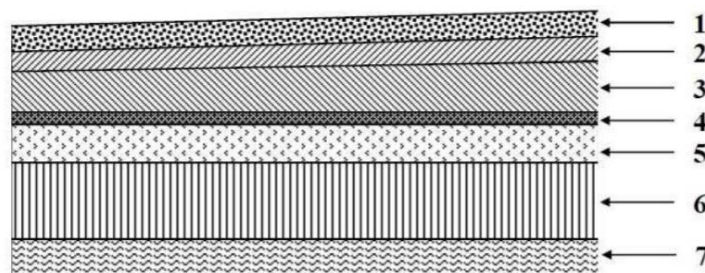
Coupe verticale du plancher terrasse inaccessible.
